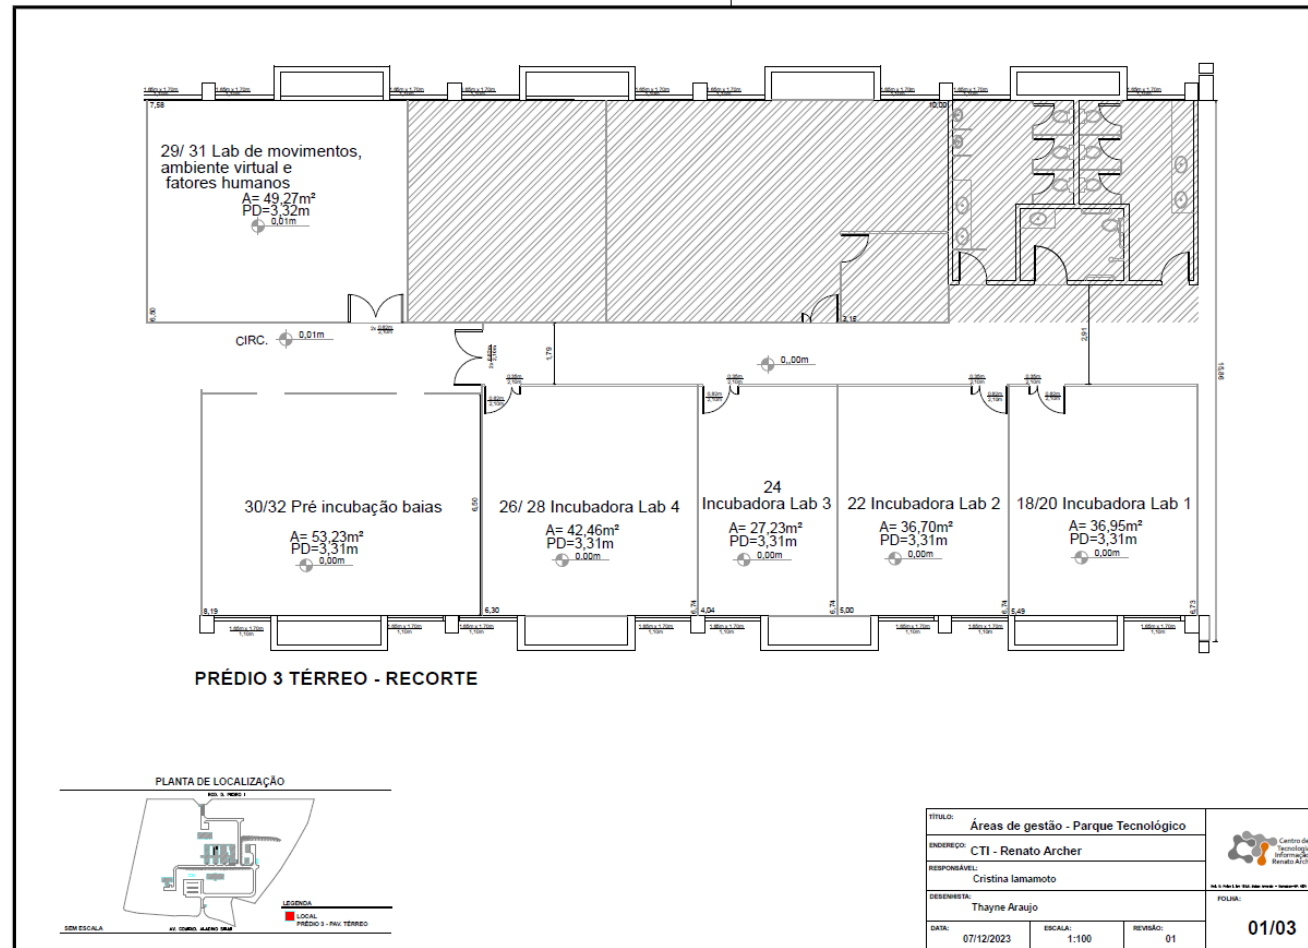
Planta baixa da área do projeto piloto da incubadora do Parque Tecnológico CTI-Tec.
